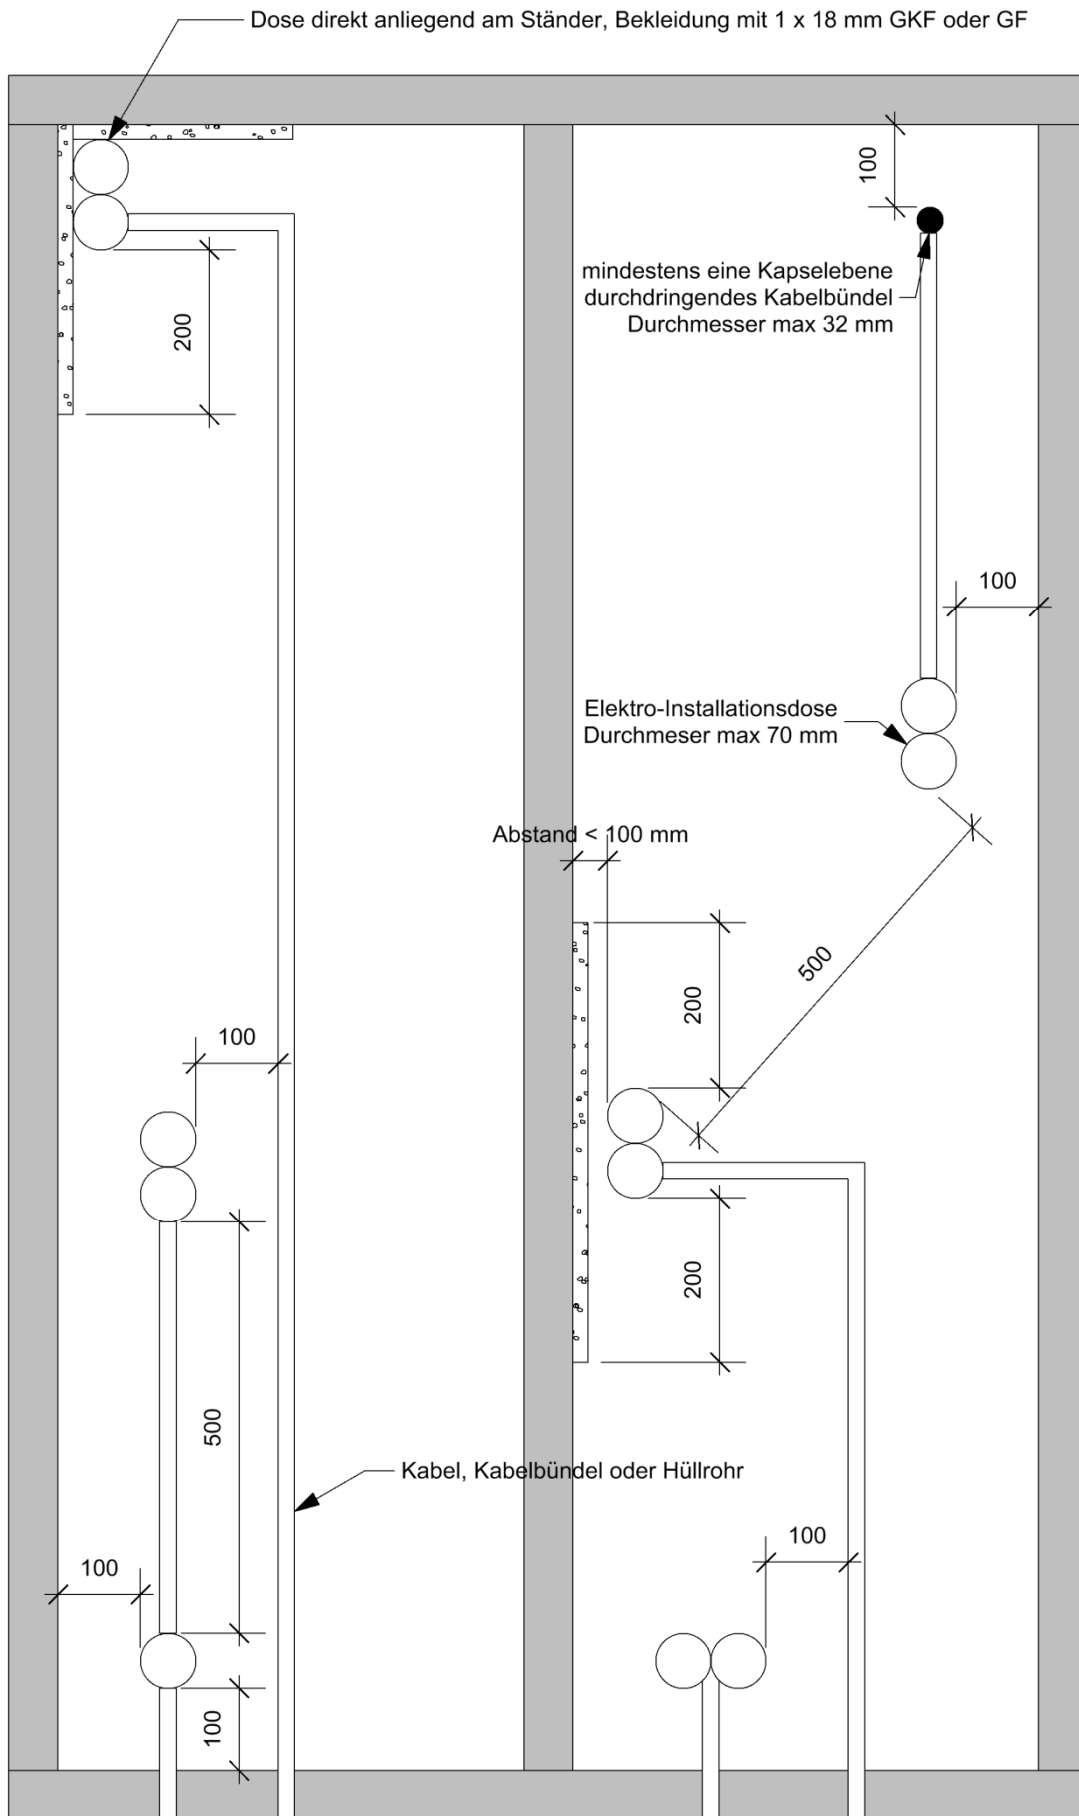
Einbauempfehlung von Elektroinstallationen in Ständerbauwände, Maße in mm
